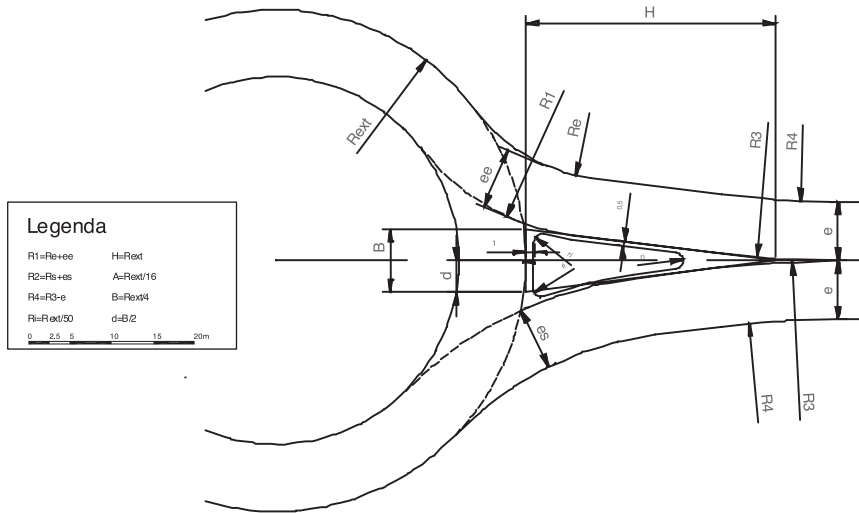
Traçado do ilhéu separador - Rotundas com raio exterior inferior a 15 metros (SETRA, 1998)
